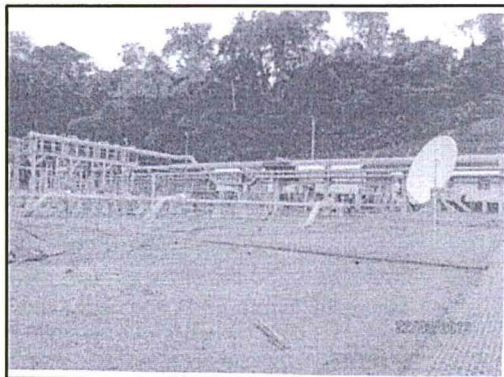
Pozo 57-29-1XST y Fotografía N° 6 Área de Testing
